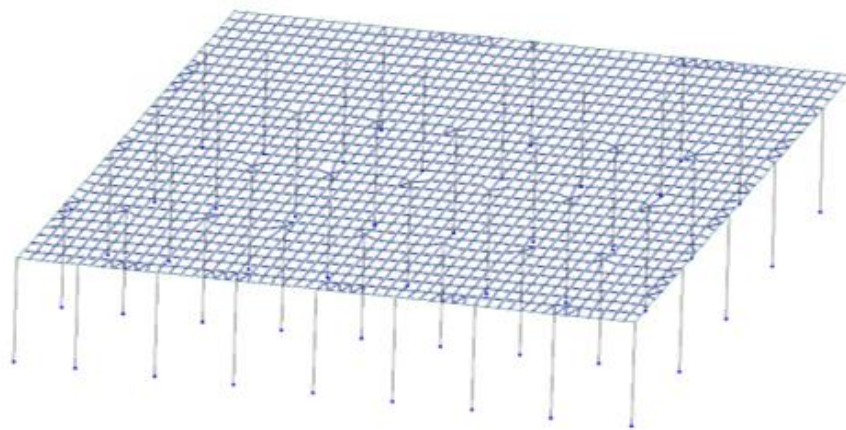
Расчетная схемы плиты перекрытия. Общий вид
